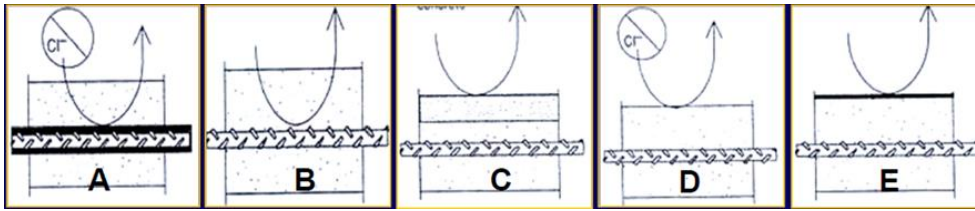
Técnicas de proteção das armaduras contra a corrosão induzida por cloretos em estruturas novas (adaptado de Correia, 2011).
